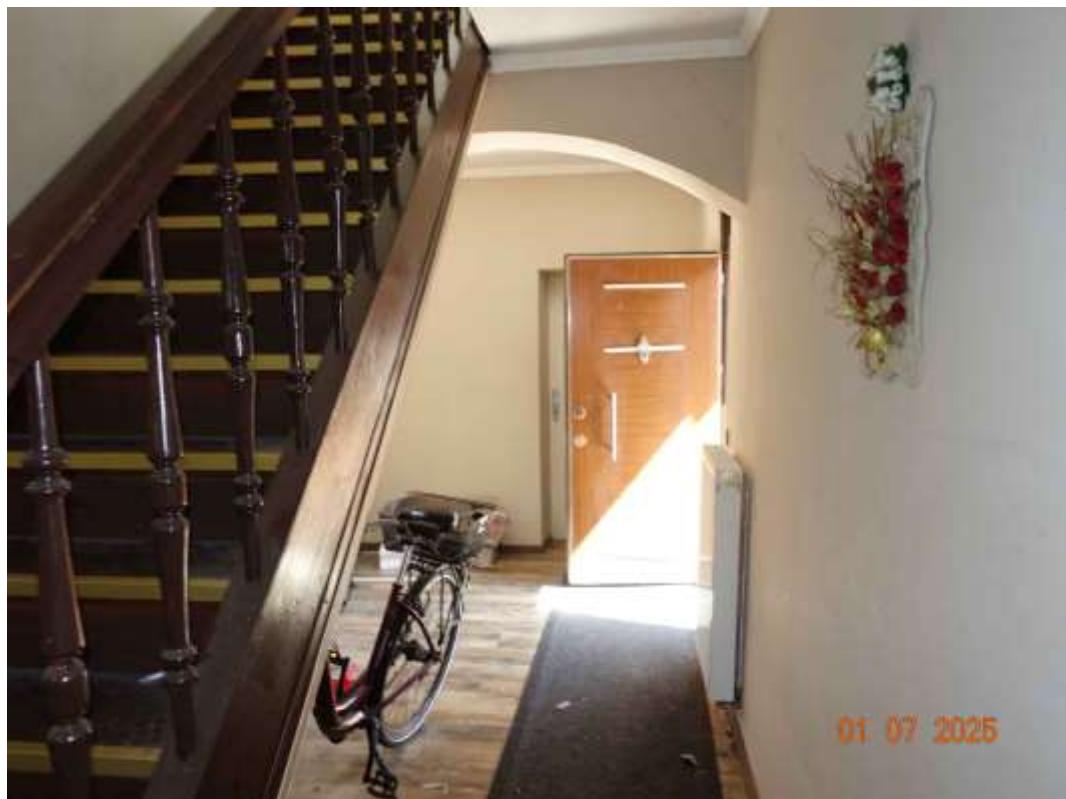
Östlicher Hauseingangsbereich und Treppenführung zum Obergeschoss
